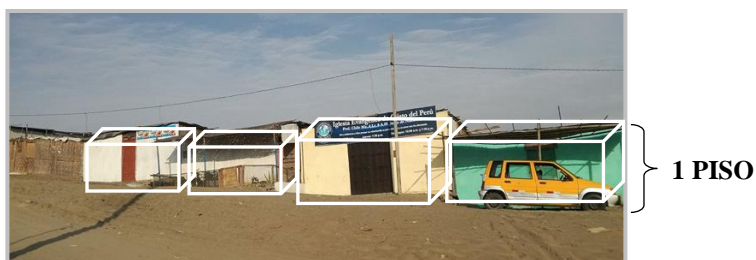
Fachadas de las viviendas que conforman Jesús de Nazaret, 2020
